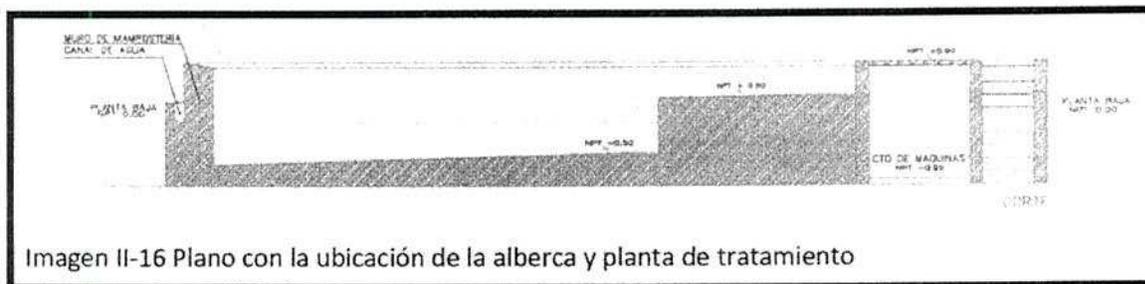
Plano con la ubicación de la alberca y planta de tratamiento
